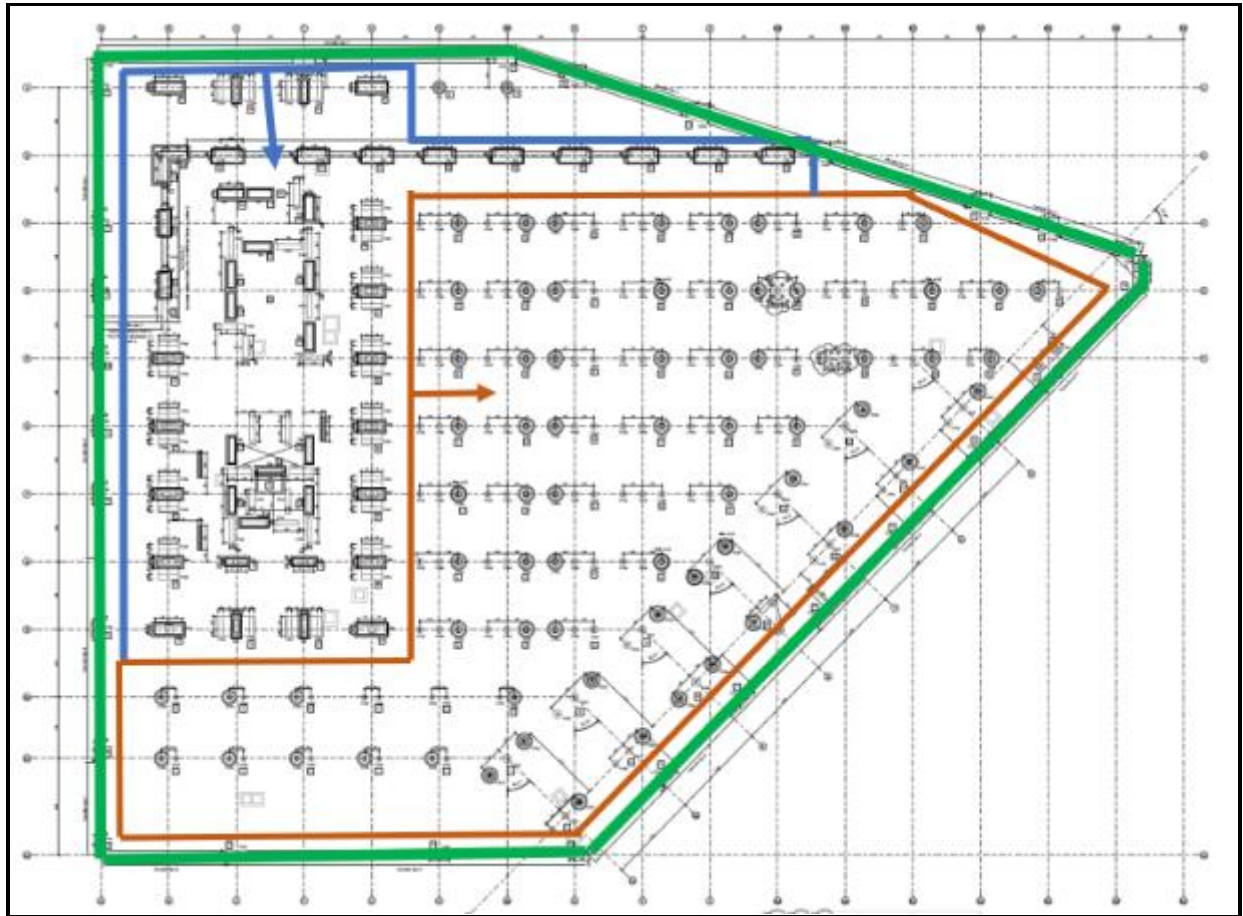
Planta Localización de Pilotes, Barretes, Pantallas y Pantalones.
